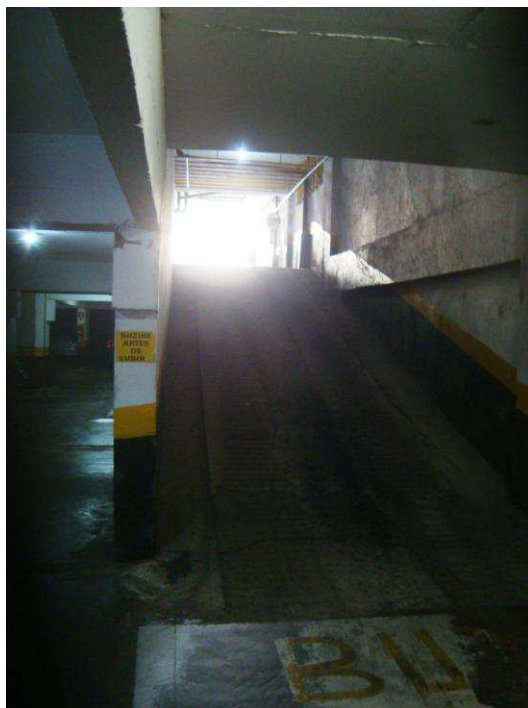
Vista parcial da rampa de acesso de uma das entradas do estacionamento
